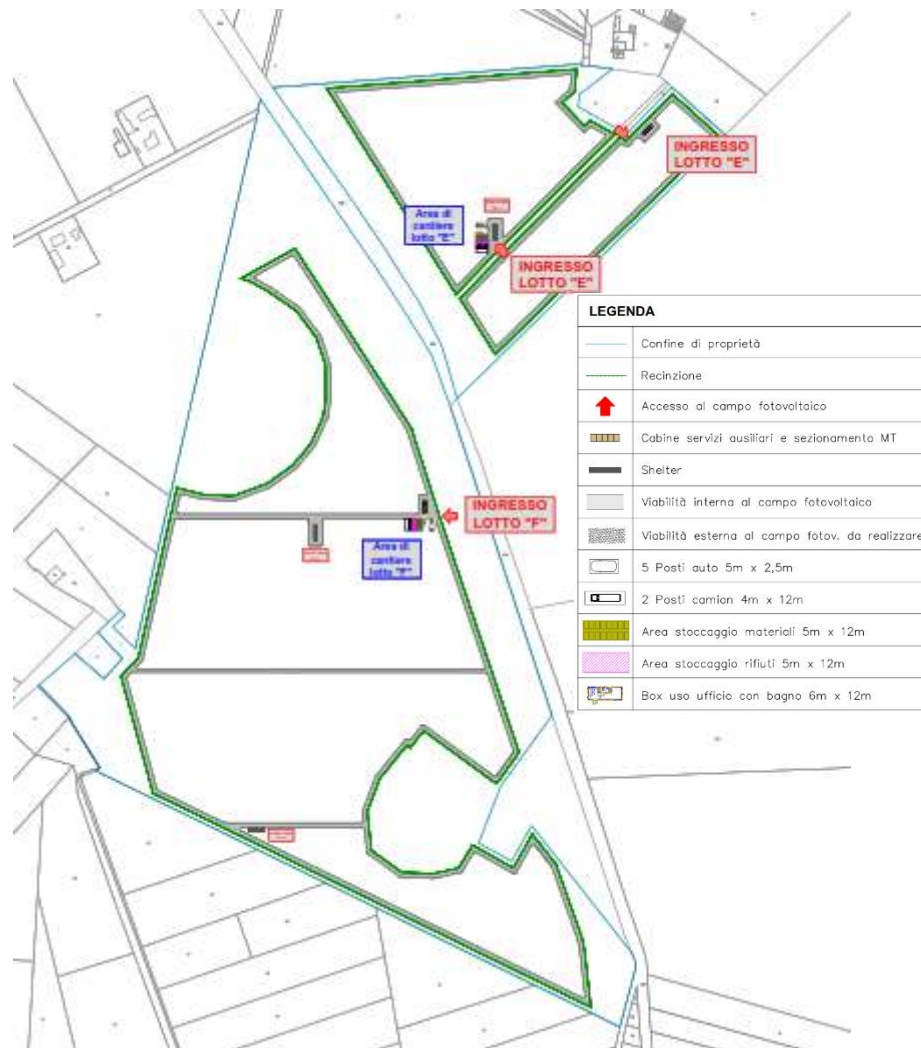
Posizionamento area di cantiere temporaneo Blocchi "E" – "F"
